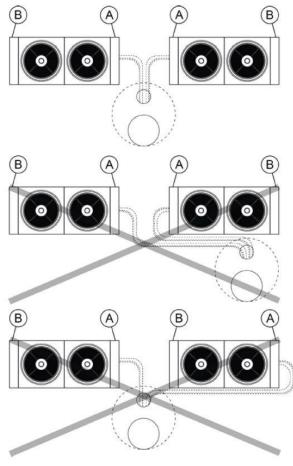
Collegamento simmetrico delle linee interrate dal pozzetto per il modello AIR 80 C 2
